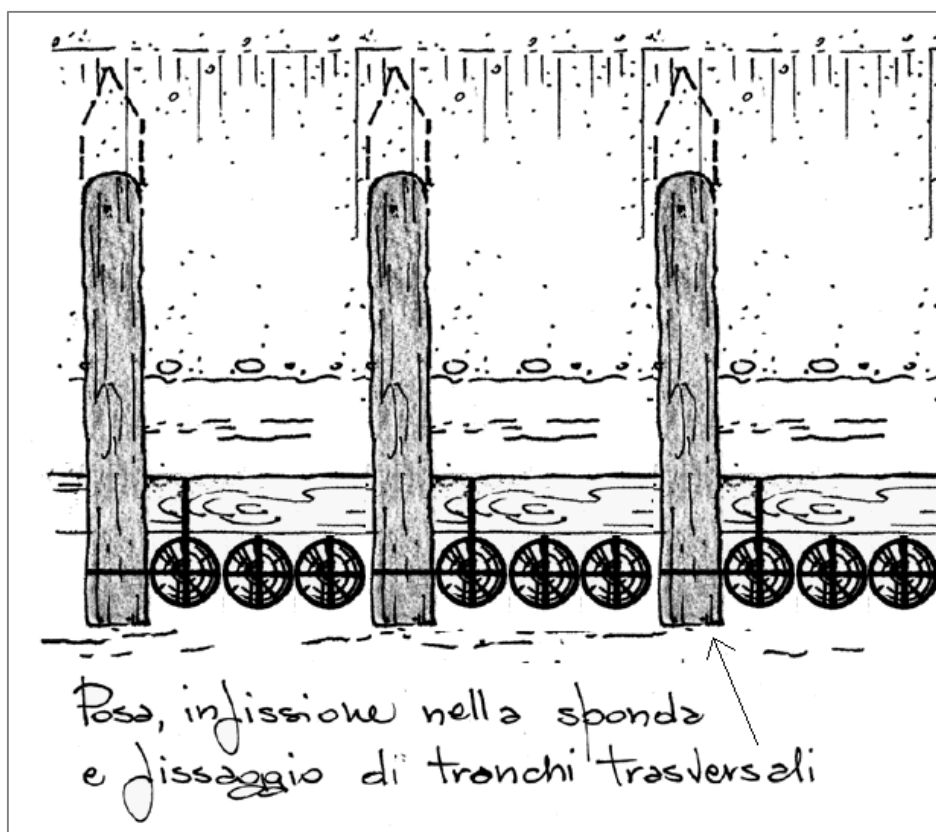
Posa primo ordine di tronchi trasversali. Pianta
